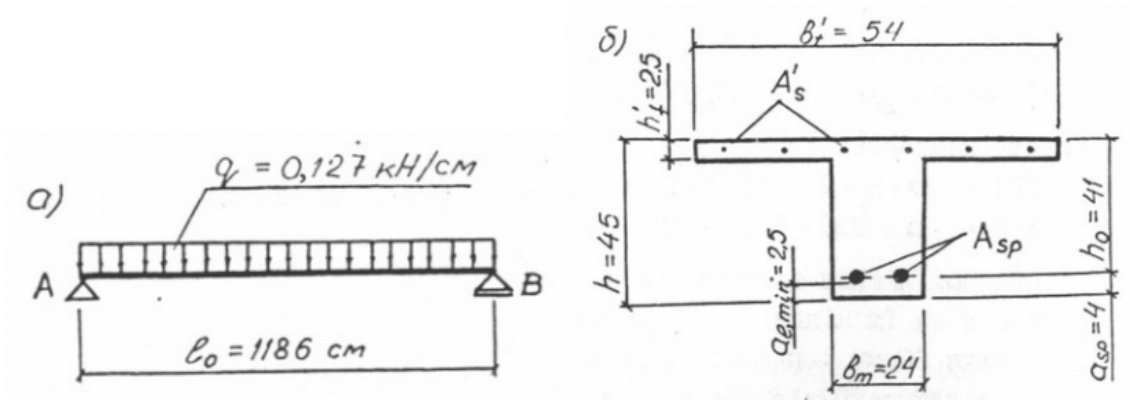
Розрахункова схема та зведений розрахунковий переріз поздовжніх ребер
